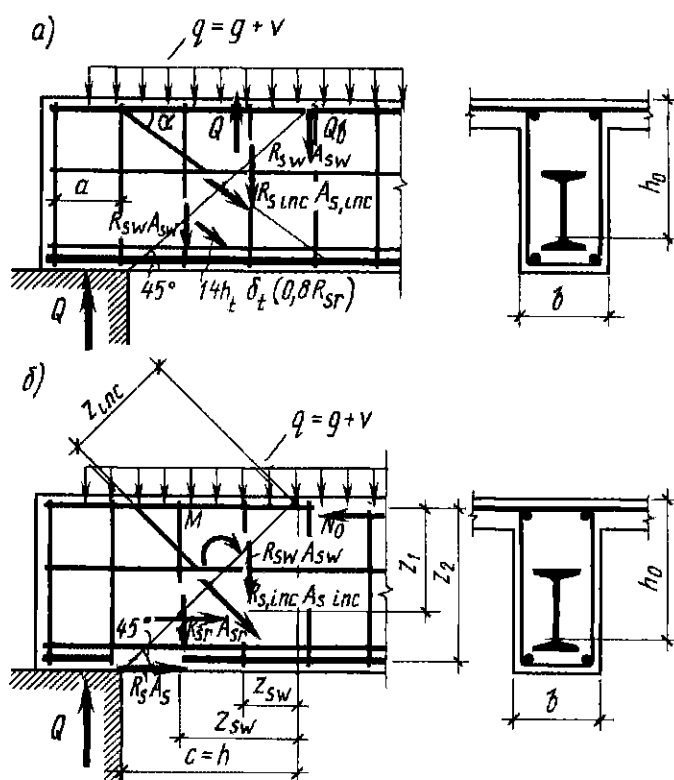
К расчету элементов с жесткой арматурой по наклонным сечениям
